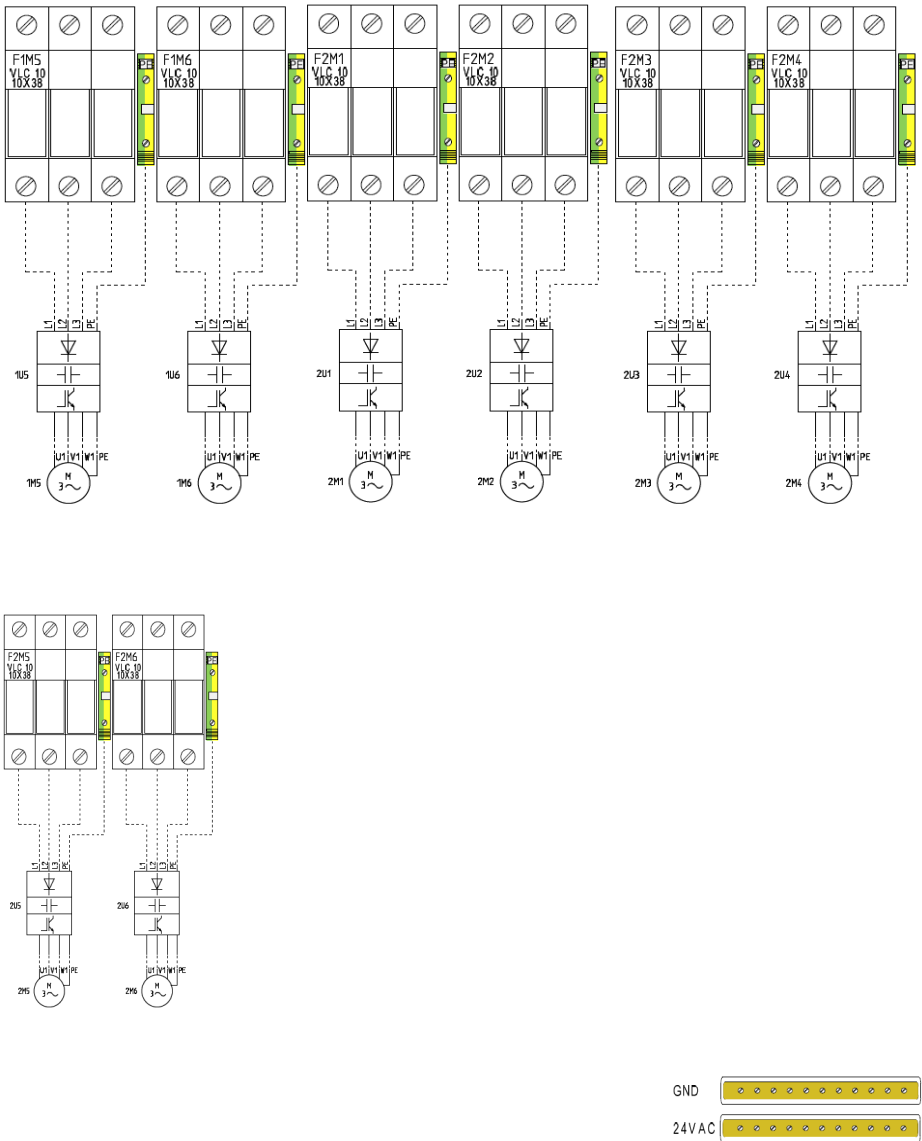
Схема питания для инверторов с 3-фазным питанием 3×400VAC (двенадцать вентиляторов до 11кВ)
